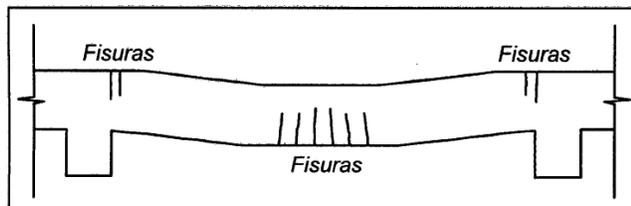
Fisuración por esfuerzos de tracción en vigas
